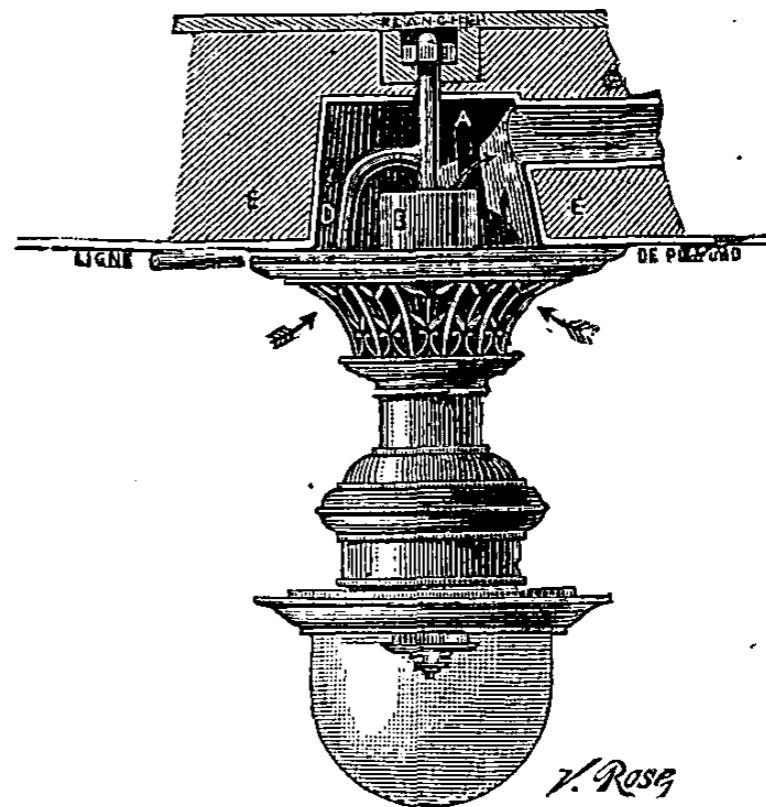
Type de lampe appliquée au plafond avec disposition spéciale pour la ventilation.
